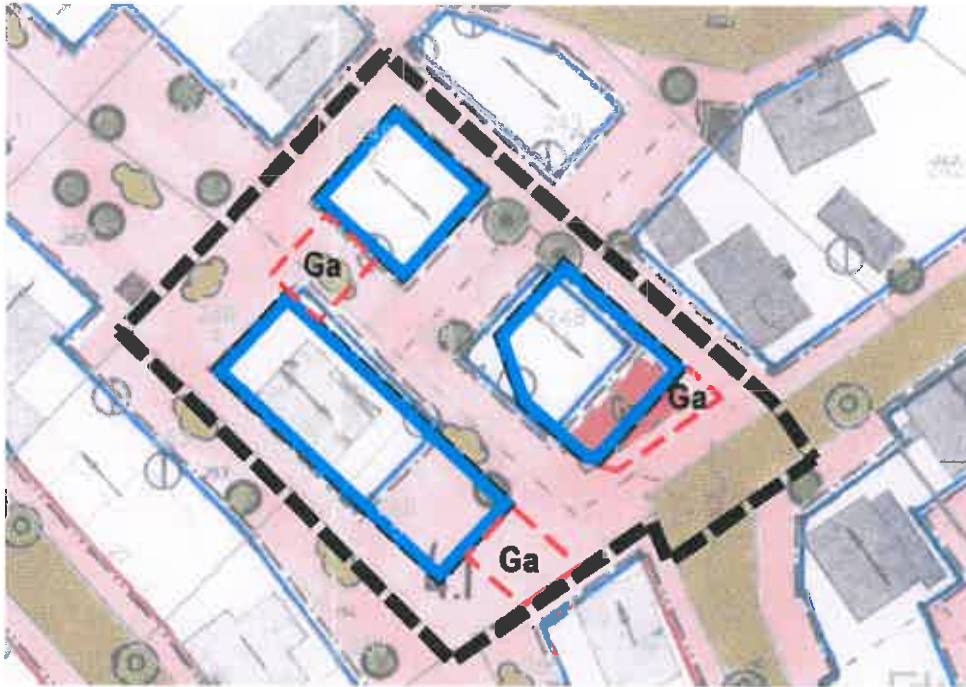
Überlagerung der neuen Baufenster mit dem ursprünglichen Bebauungsplan
